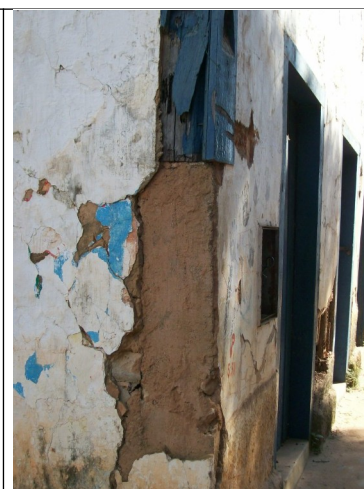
Pé de esteio substituído por pilarete de concreto.
